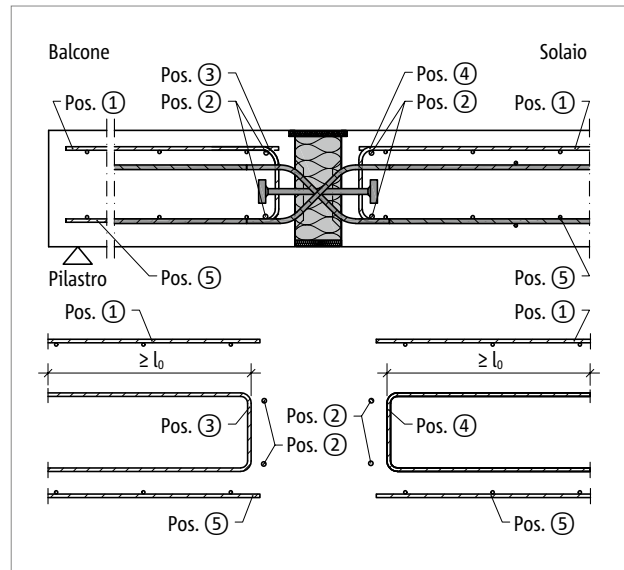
Schöck Isokorb® T tipo QP-VV: armatura in opera
